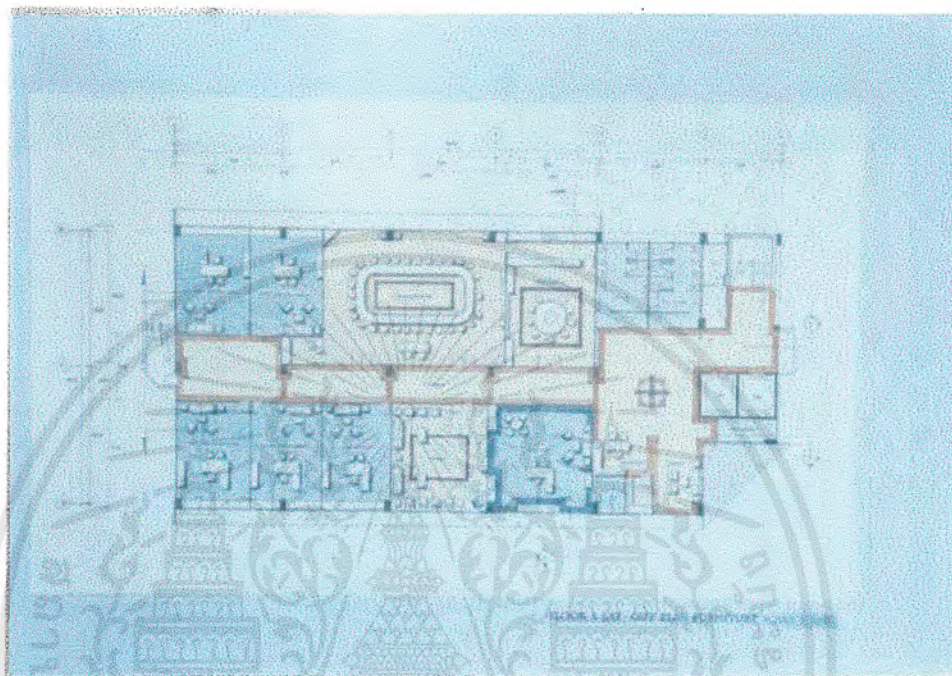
แสดง FLOOR 1 LAY-OUT FURNITURE PLAN
